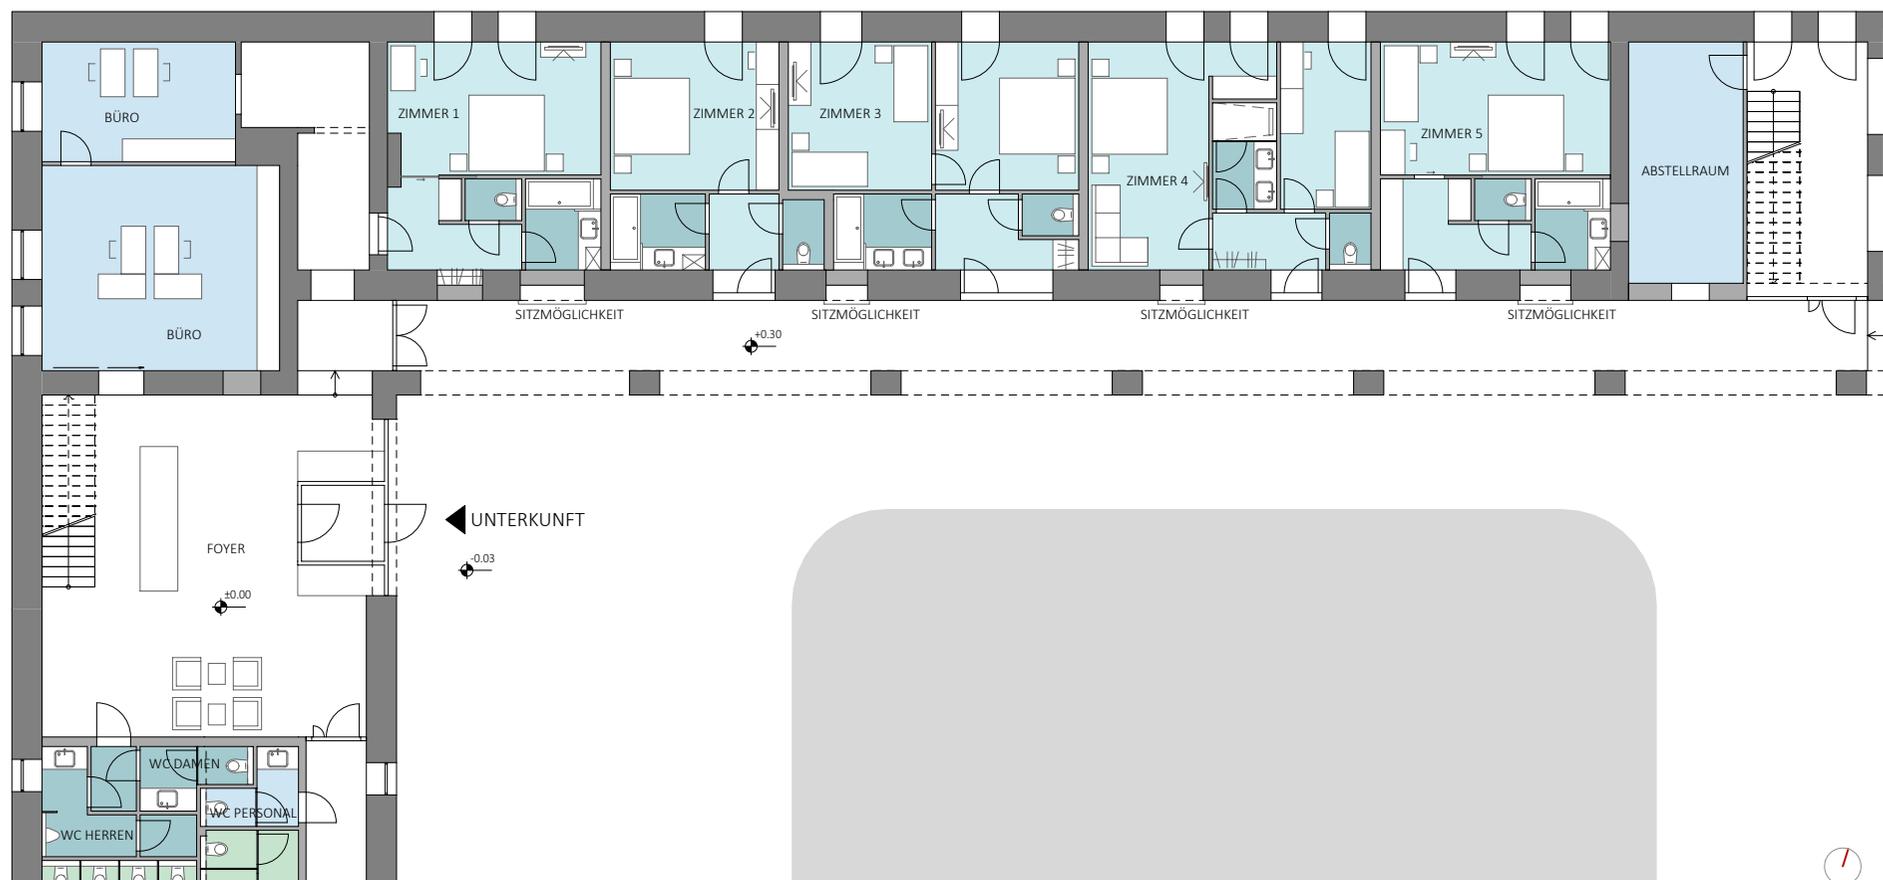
Erdgeschoss Unterkunft, M 1:200
